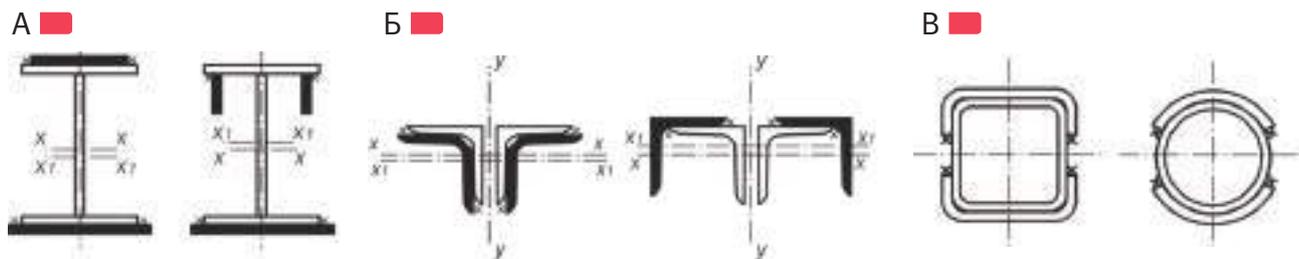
Усиление стальных элементов перекрытий: А – балок; Б – стержней ферм из парных уголков; В – стержней ферм из гнутосварных замкнутых профилей и труб
